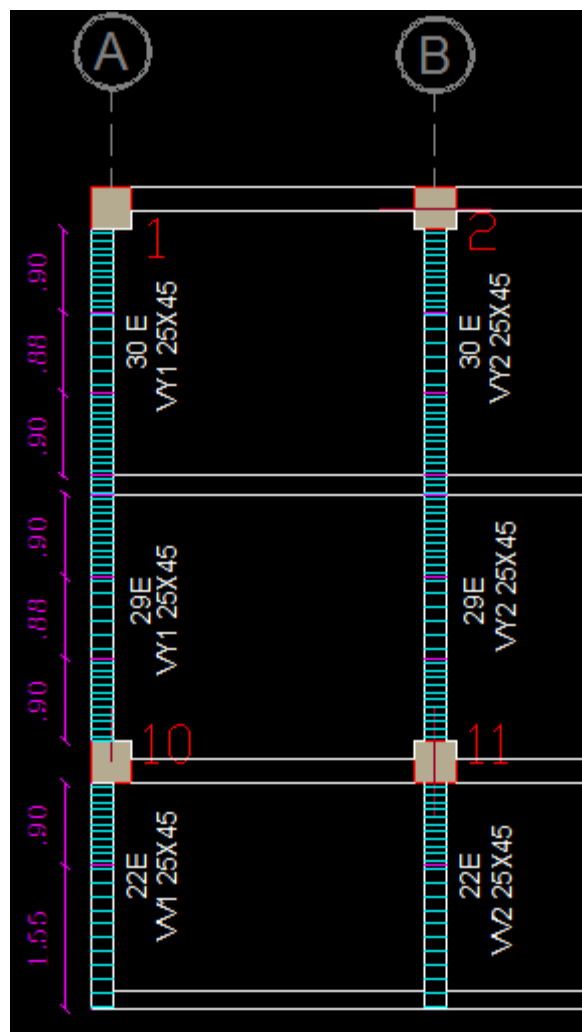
Ubicación de estribos en vigas en la dirección Y, N+7.20.
